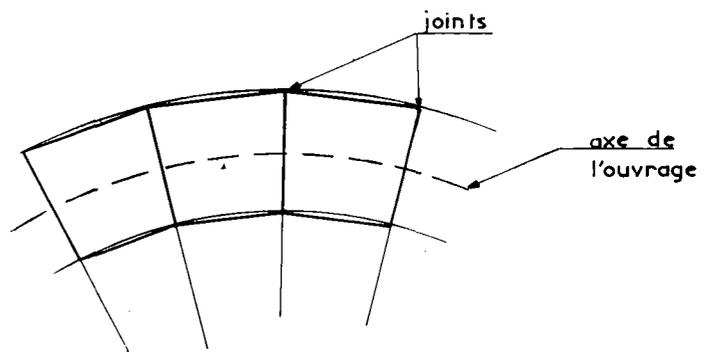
Découpage des voussoirs (en plan) pour un ouvrage courbe.
